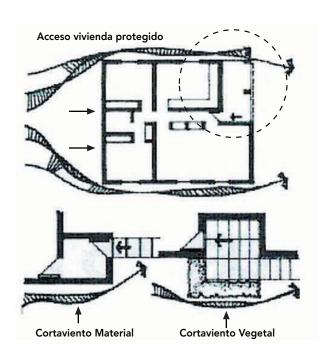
50: Ubicación y protección del acceso a la vivienda.
